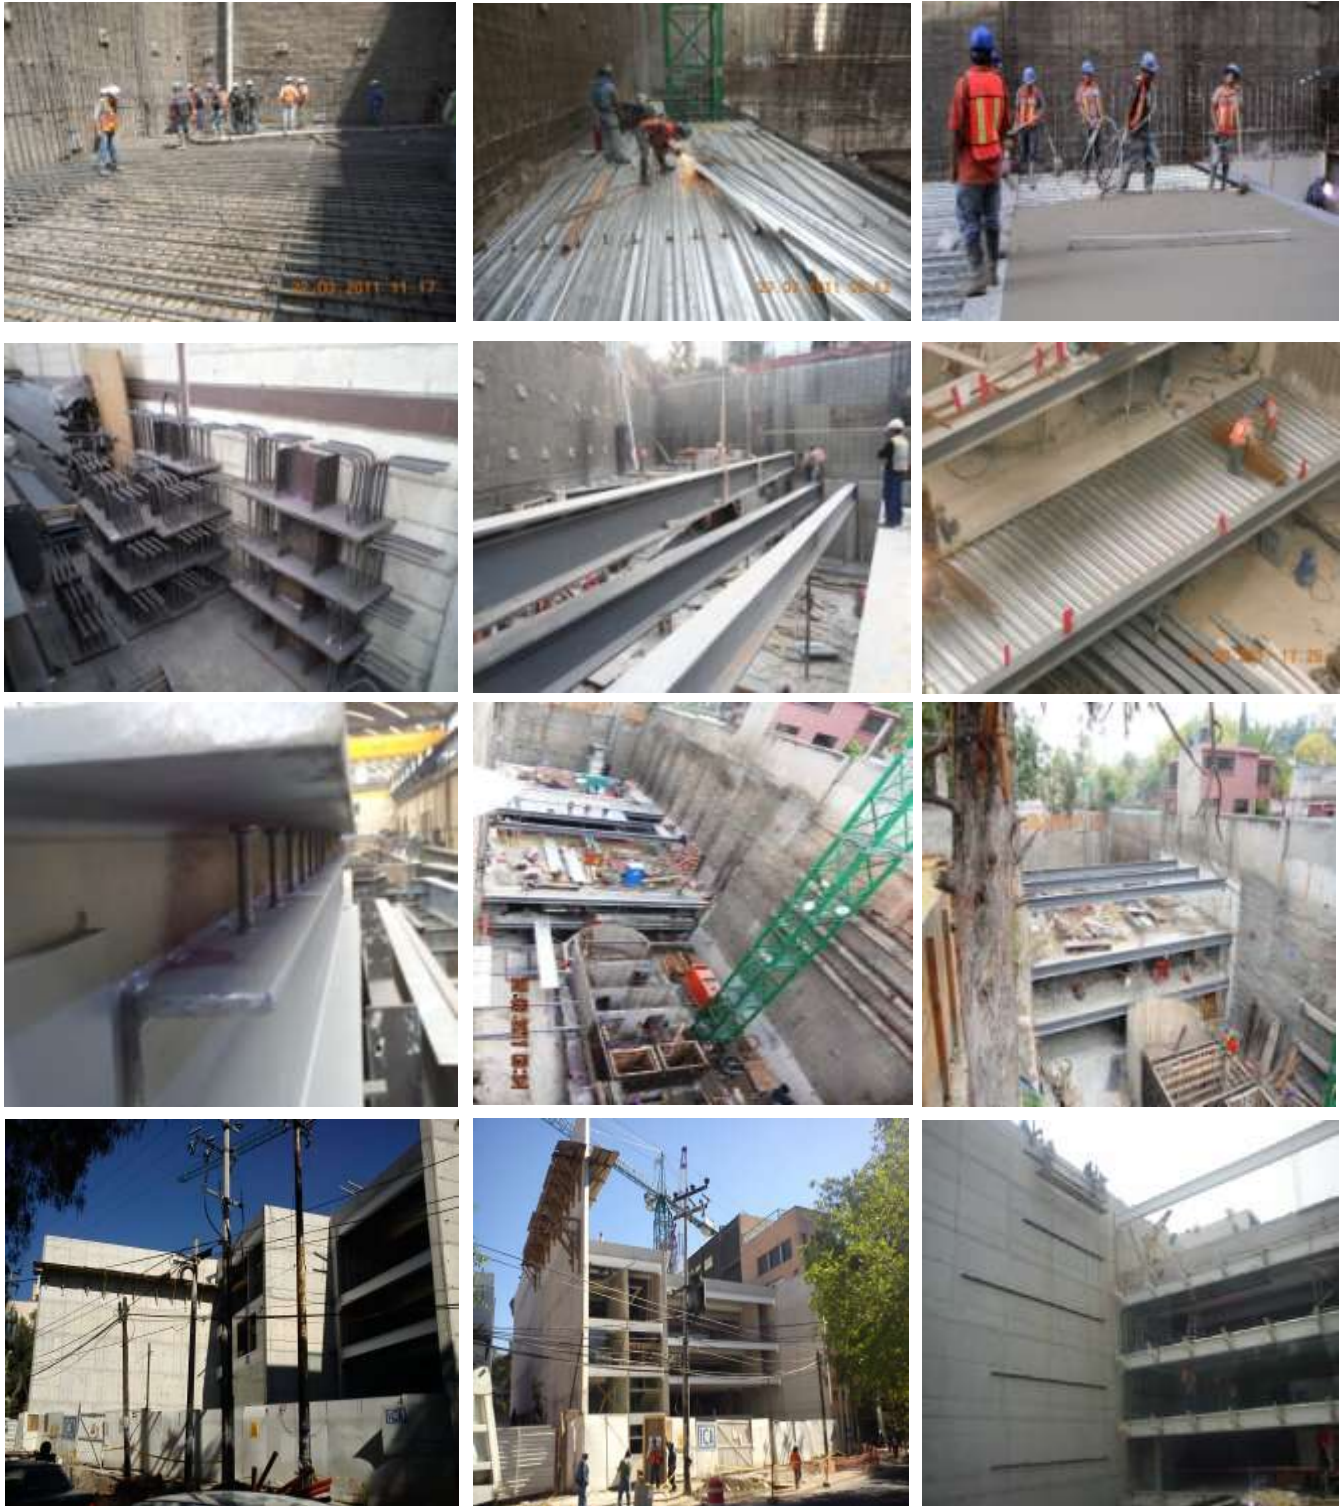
Procedimiento de la Estructura Metálica y de Concreto de la Nueva Sede Alternativa del CENEVAL
